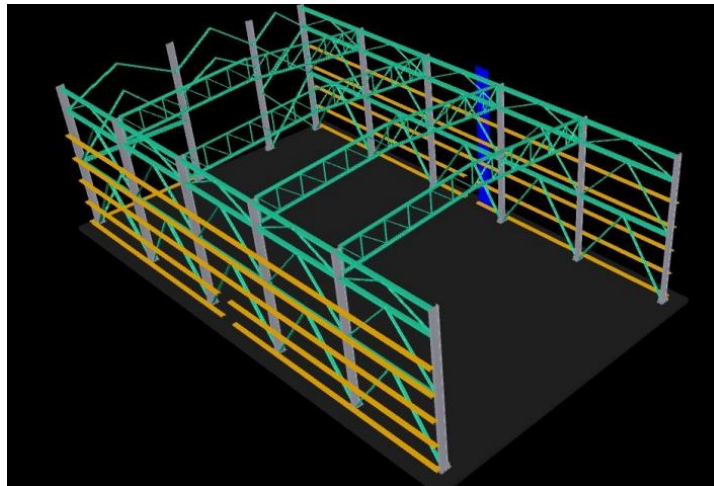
Montaje de columnas eje A- F y cuerdas superiores
